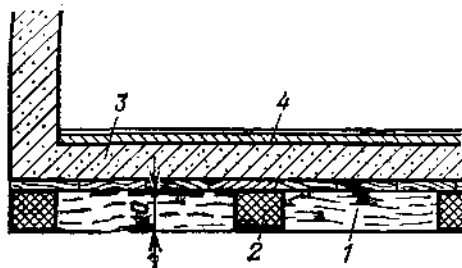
Схема устройства плавающего основания под кабиной наблюдения:
